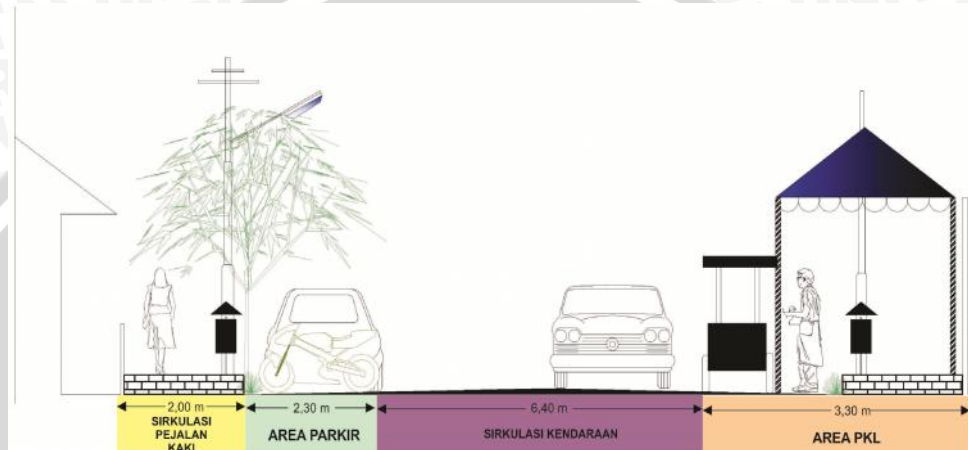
Dimensi Ruang Parkir *On-Street
